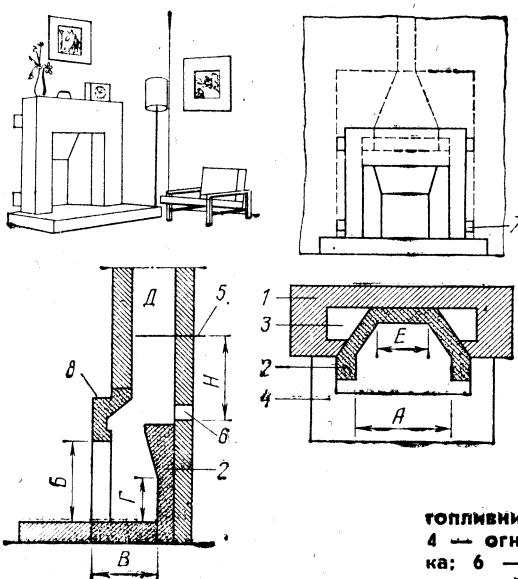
Английский камин с прямым дымоходом: А — ширина портала; Б — высота портала; В — глубина топливника; Г — высота задней стенки; Е — ширина задней стенки; Н — высота дымосборника; 1 — корпус камина; 2 — стены топливника; 3 — тепловая камера; 4 — огнеупорный пол; 5 — задвижка; 6 — прочистка; 7 — отдушина тепловой камеры; 8 — каминная полка
